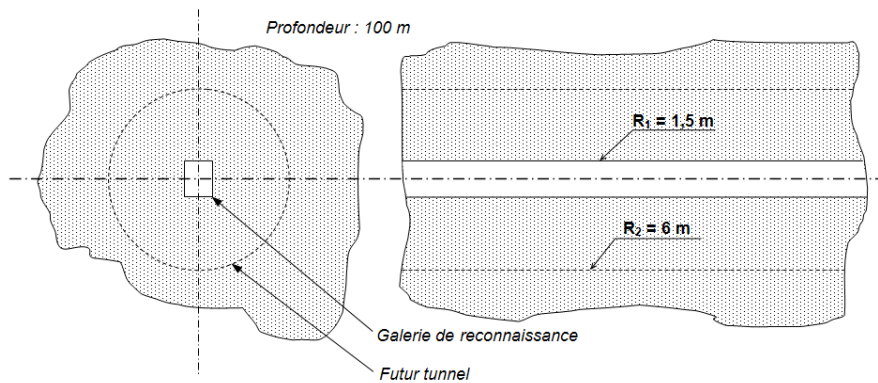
Tunnel et galerie pilote de reconnaissance.
